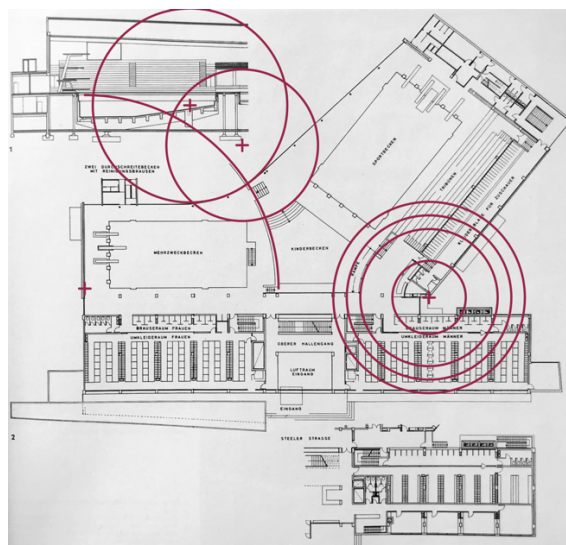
P. F. Schneider, Hauptbad Essen: Grundriss mit eingezeichneten Kreisen (ohne Einzeichnungen aus: *Baukunst und Werkform*, 1960, Heft 9, S. 489)
